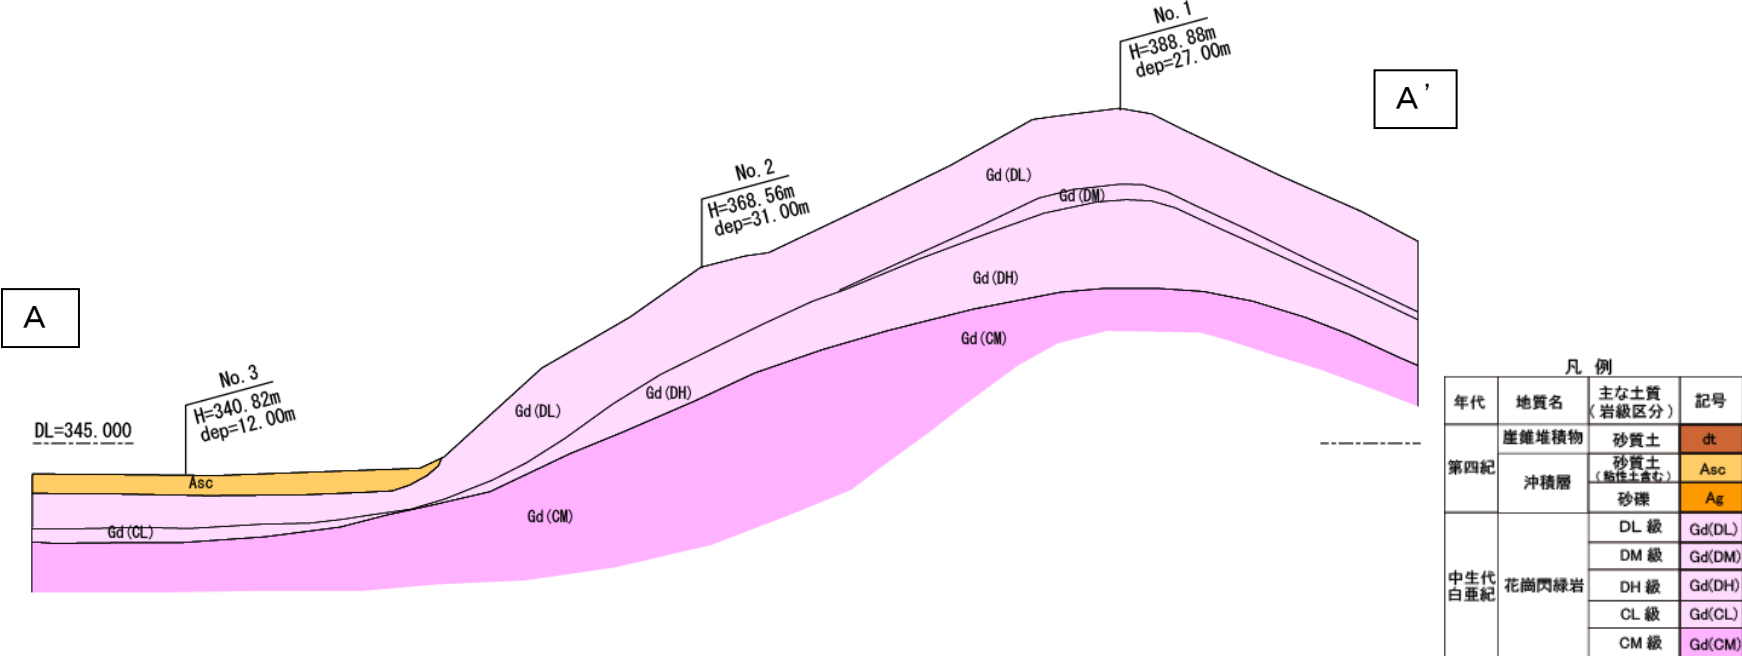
(1) 推定地質断面図 (A-A' 断面)
